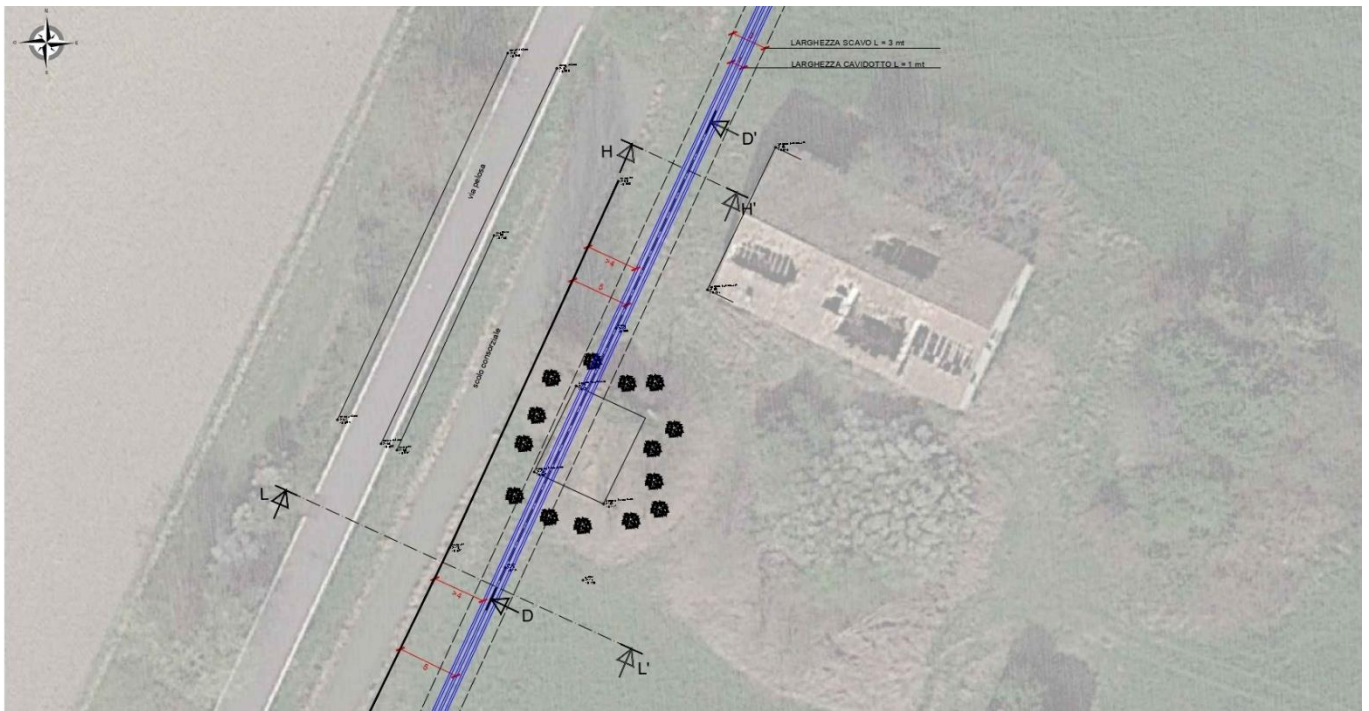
Tratto D-D'- Rilievo planoaltimetrico post-intervento
